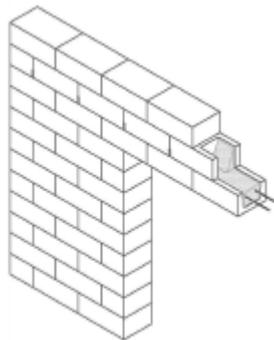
formazione dell'architrave di porta con blocco a canaletta riempito in calcestruzzo armato
